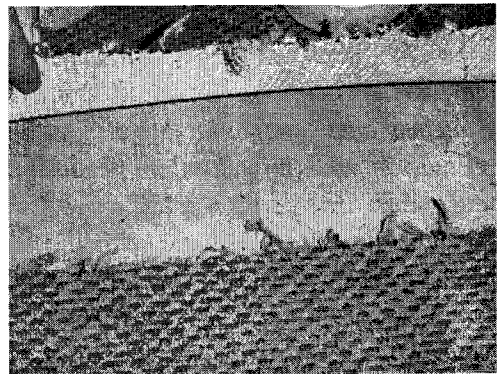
Penutup lantai *raised floor* dari bahan kayu parket yang secara langsung memberikan tampilan estetik.
